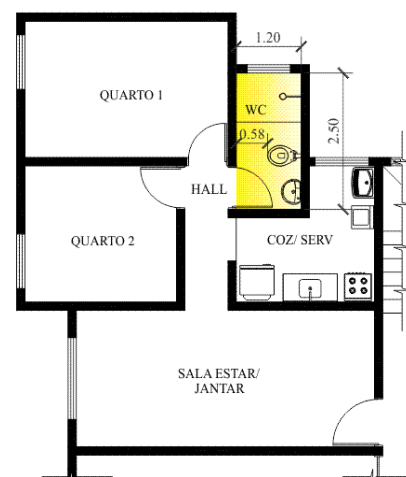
Planta Baixa Pav. Tipo: Setor Íntimo do Residencial Germano Santos (sem escala)
